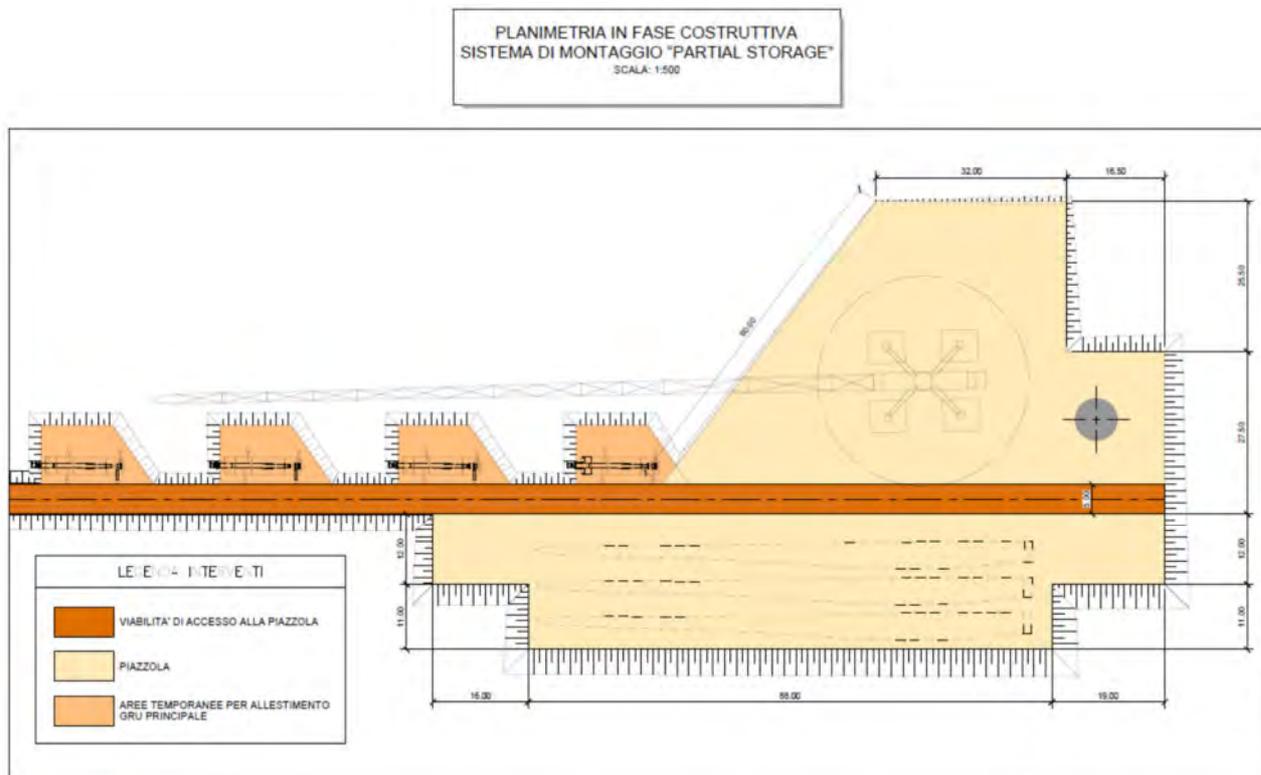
Struttura tipo di una piazzola di cantiere.
